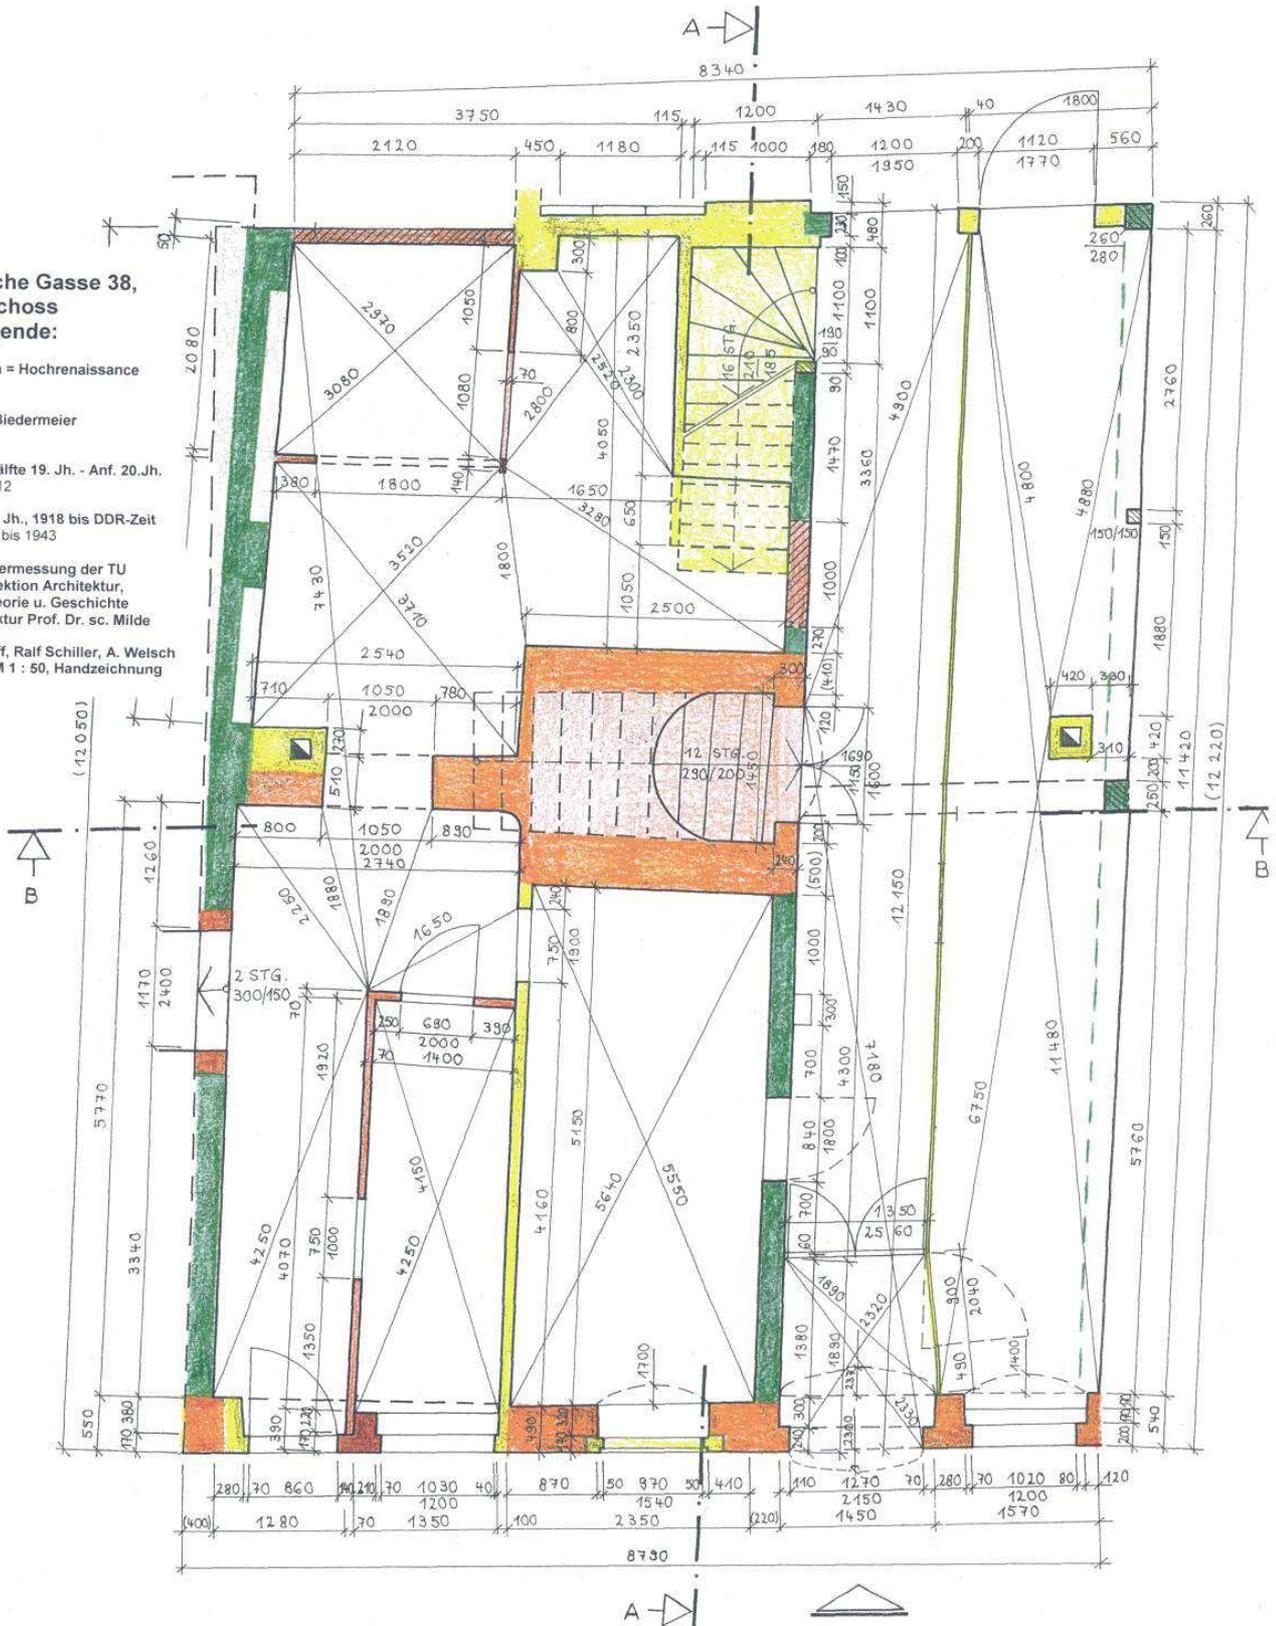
Görnische Gasse 38: Baualtersplan Grundriss Erdgeschoss
